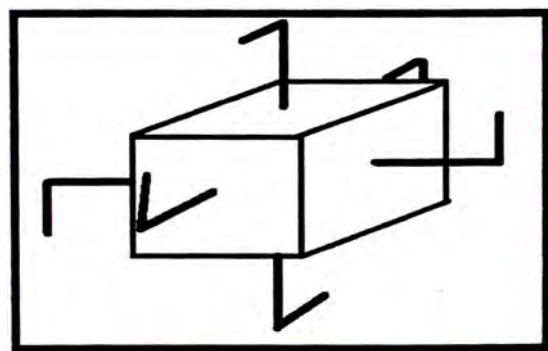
Propuesta de elemento de concreto para manto principal
